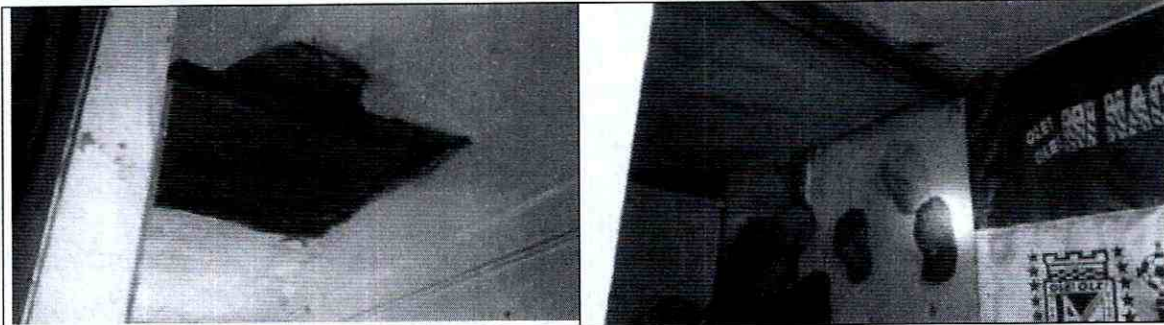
Detalle interior del inmueble, detalle de la combinación de tipos de mampostería.
